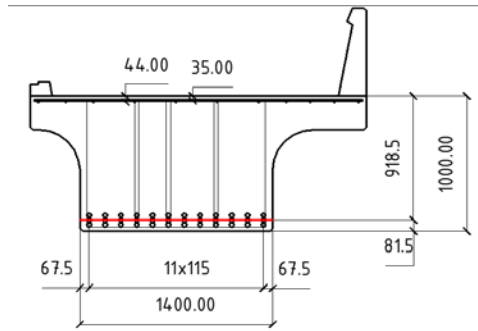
Плитна прогонова будова суцільного перерізу. Розташування арматури в прогоновій будові. Варіант № 1
